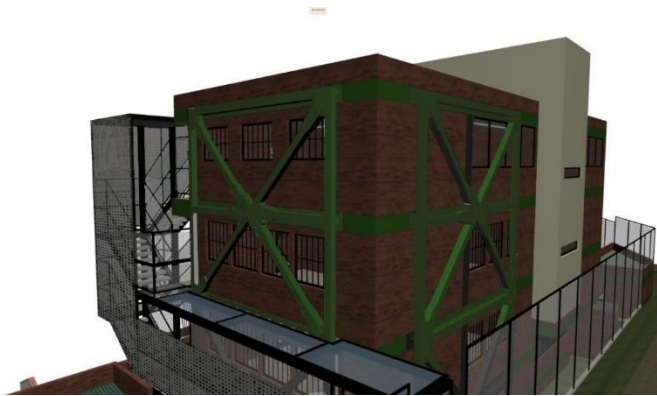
Propuesta Colores Estructura Reforzamiento y Cortasol Escalera
